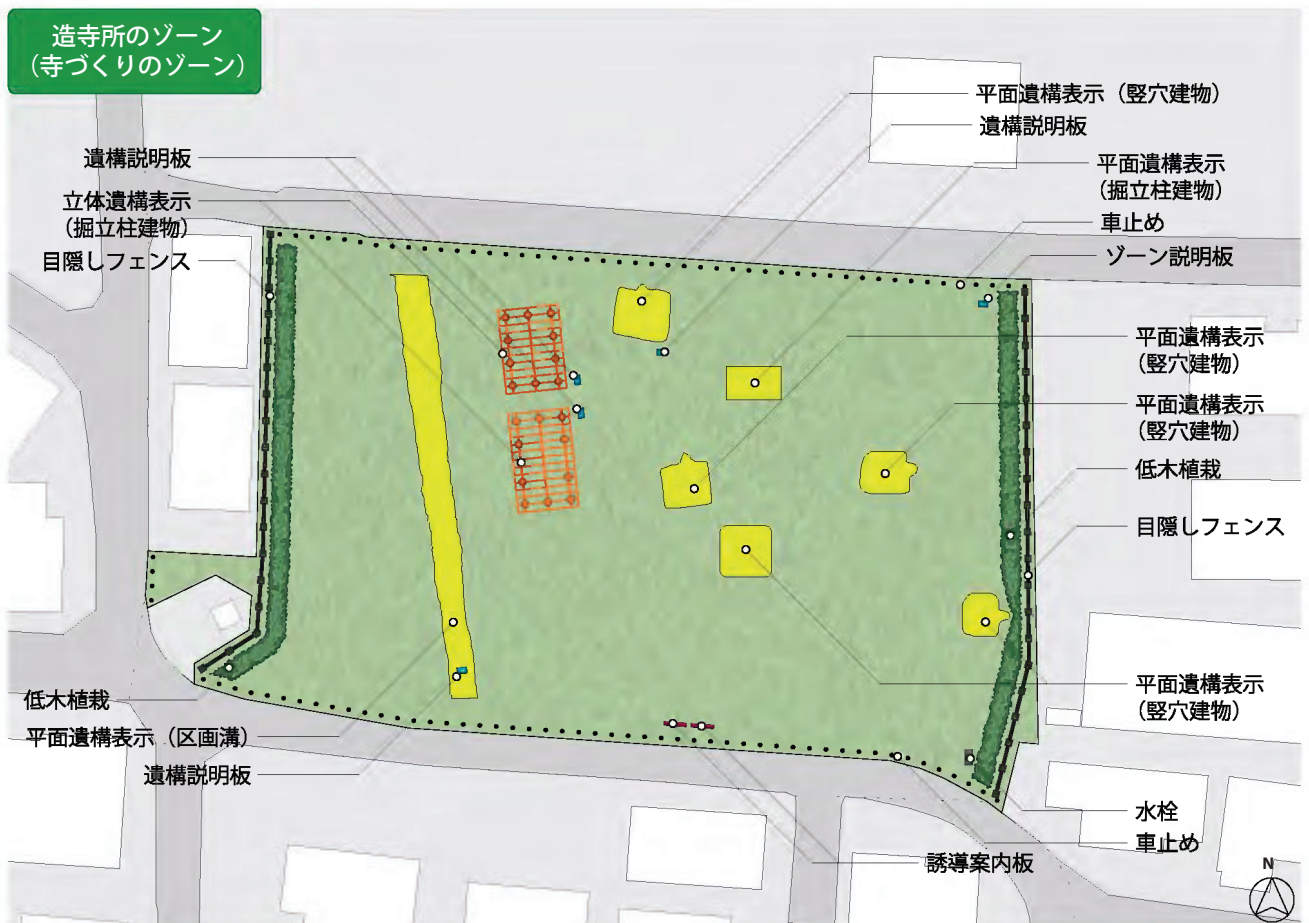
整備基本計画図 造寺所のゾーン平面図 (縮尺: 1/600)
